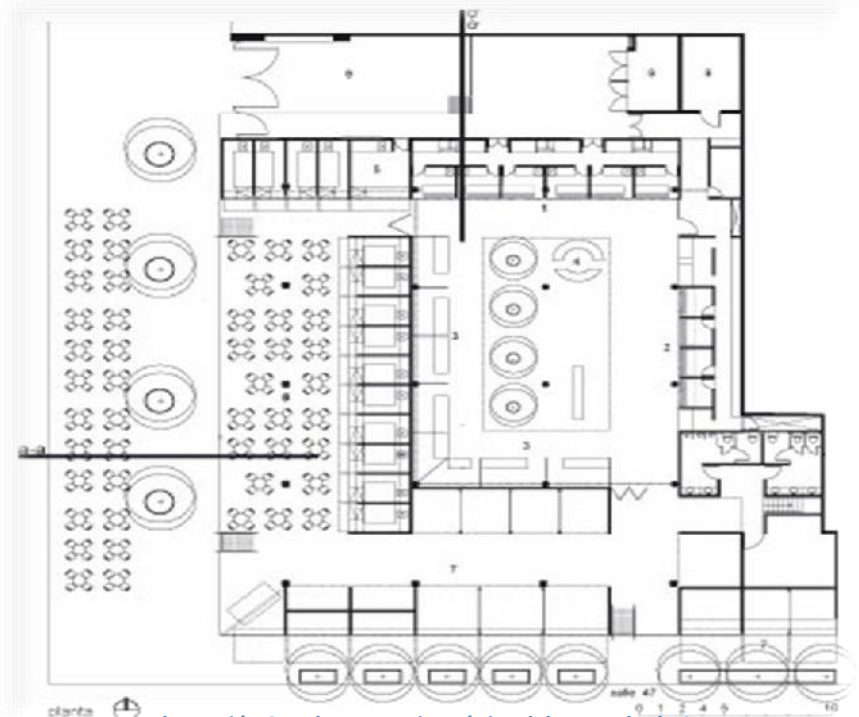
Planta arquitectónica del mercado de Santa Ana Merida. Fuente: [www. Obrasweb.mx](http://www.Obrasweb.mx)
